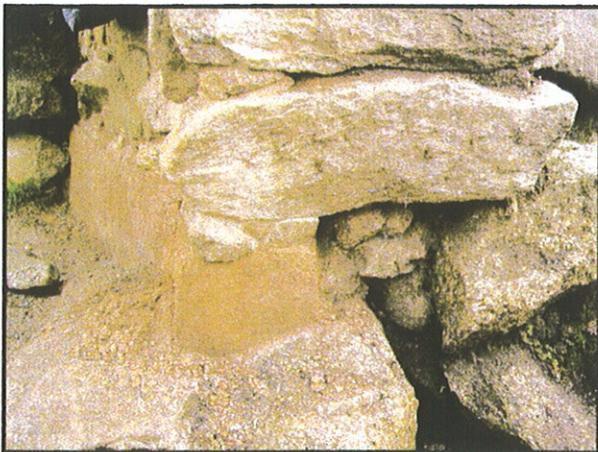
y 149: Recalce con color y vista de cómo permite mantener a la estructura en pie.
